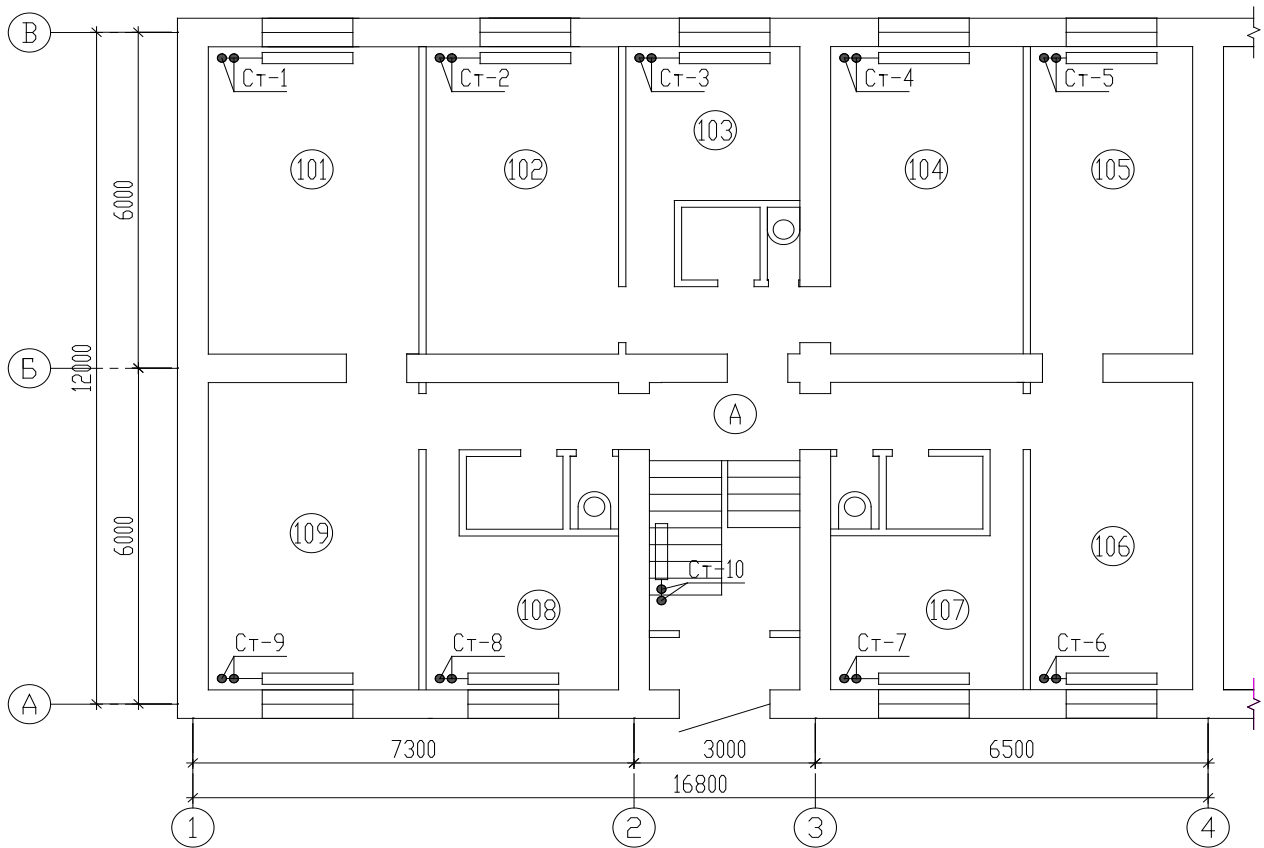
Пример расположения элементов системы отопления с нижней разводкой на плане этажа
